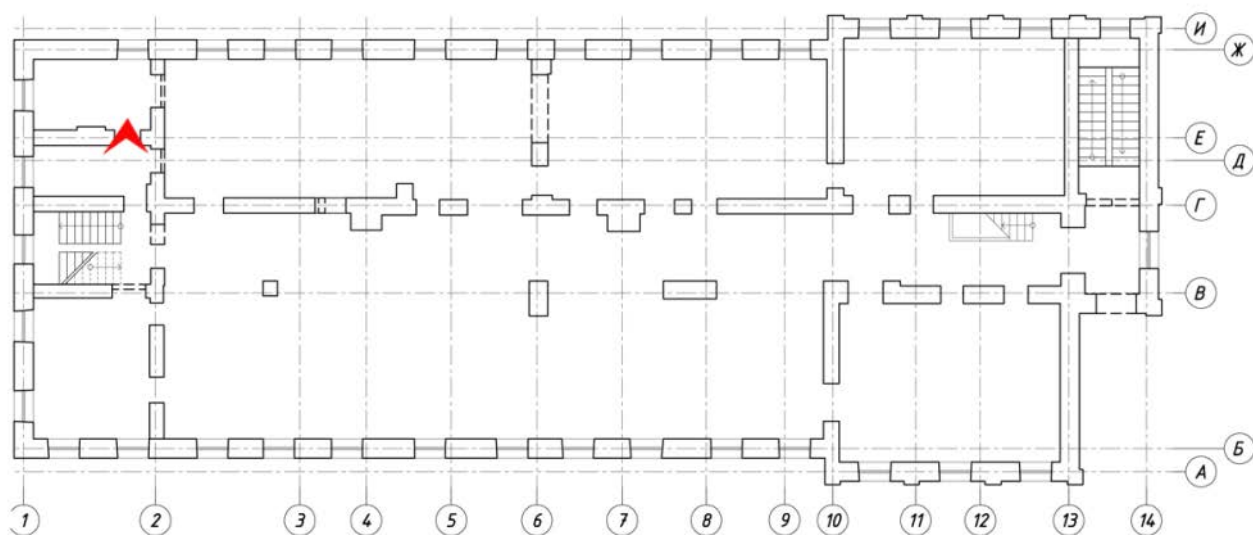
Помещение 2-го этажа в осях 1 – 2/Е – Г.
